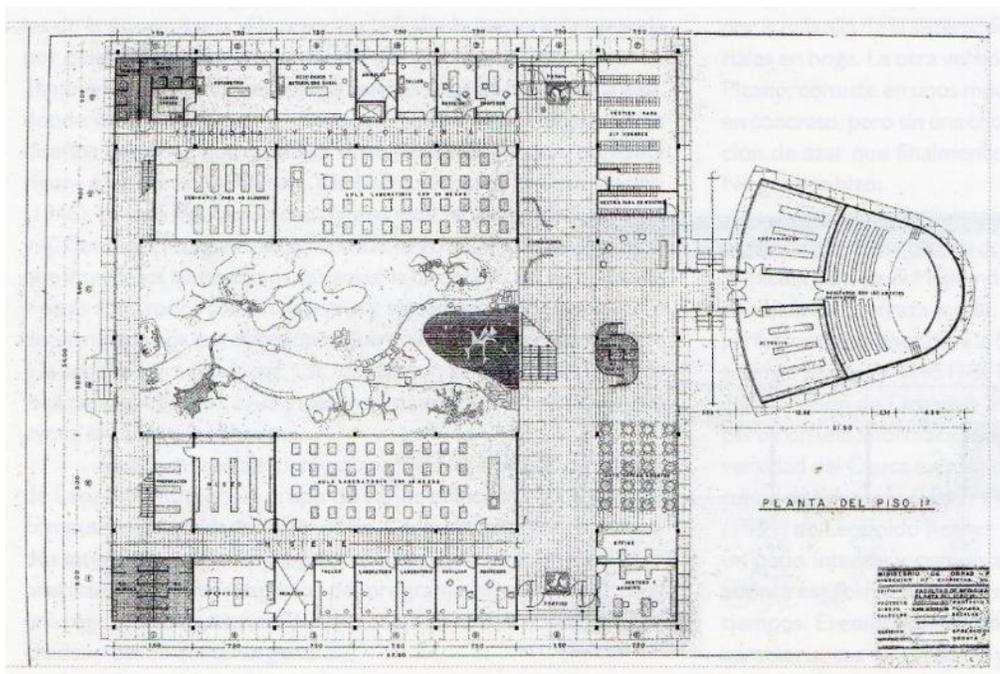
Planta Facultad de Medicina Popayán. Fuente Arquitectura y Estado.
